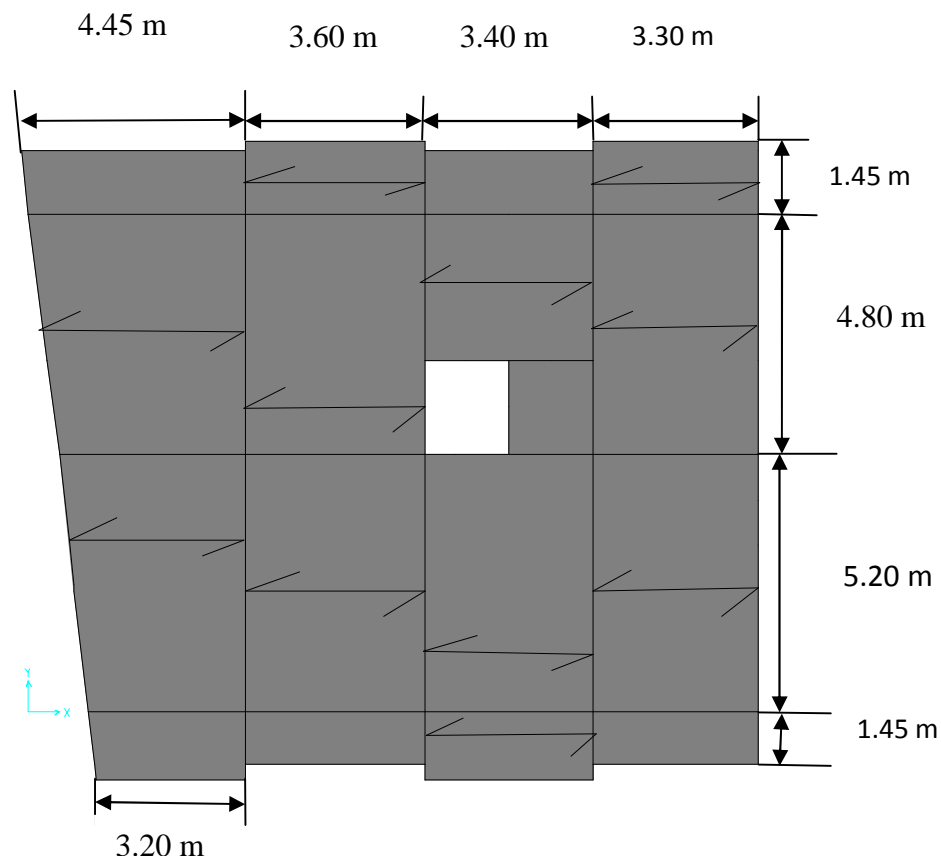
Le Schéma de la disposition des poutrelles pour les étages courants.
